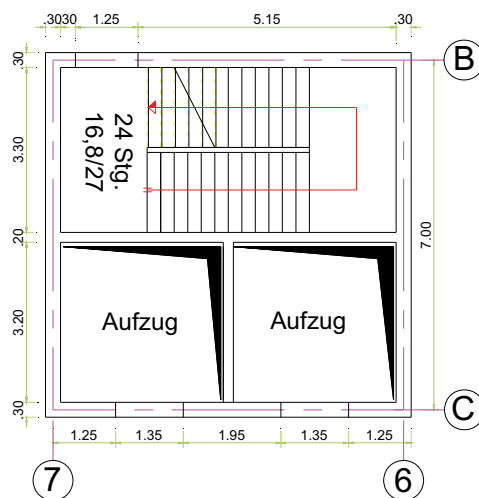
Bauteilmaße und Lastabtragung der Treppenkonstruktion im Regelfgeschoss
